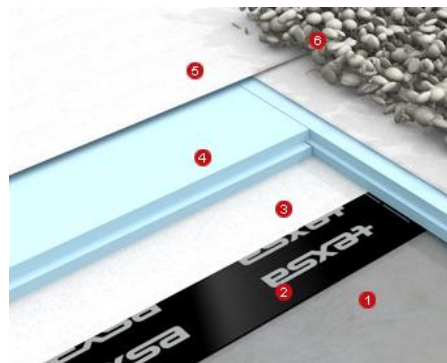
Ejemplo de cubierta acabada en grava férrea rojiza. 1. Soporte resistente y pendiente, rasallia de madera machihembrada. 2. Membrana impermeabilizante. 3. Geotextil separador. 4. Aislamiento térmico. 5. Geotextil separador. 6. Canto rodado férrico.
